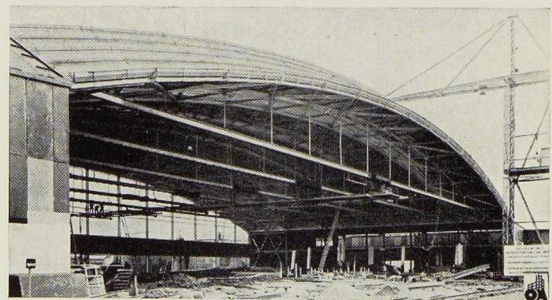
Vue d'ensemble du hall d'exposition « Stahl und Eisen ».
